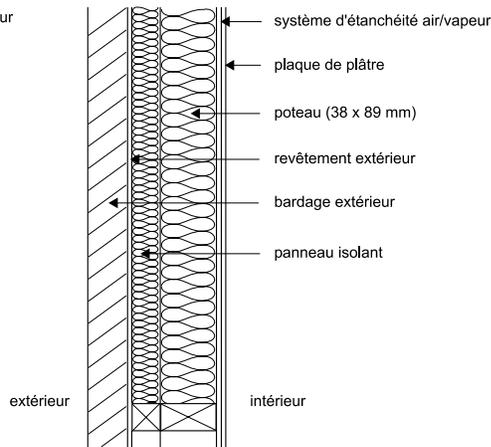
Coupe verticale d'un mur avec panneau isolant installé à l'extérieur de l'ossature murale à poteaux
